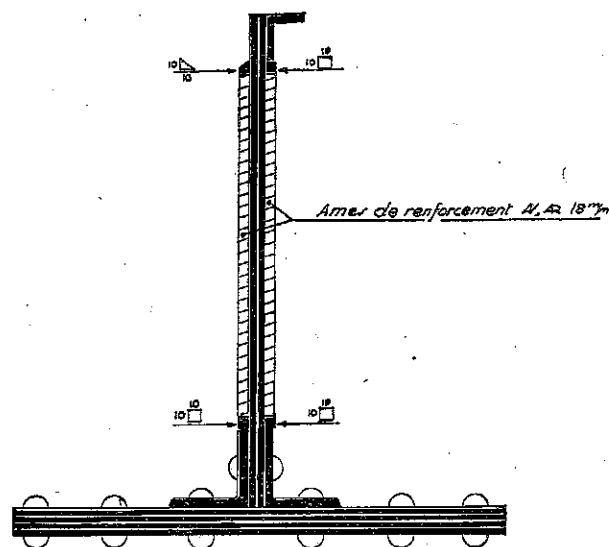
b. — Renforcement de la membrure inférieure. — Coupe suivant c-d.
